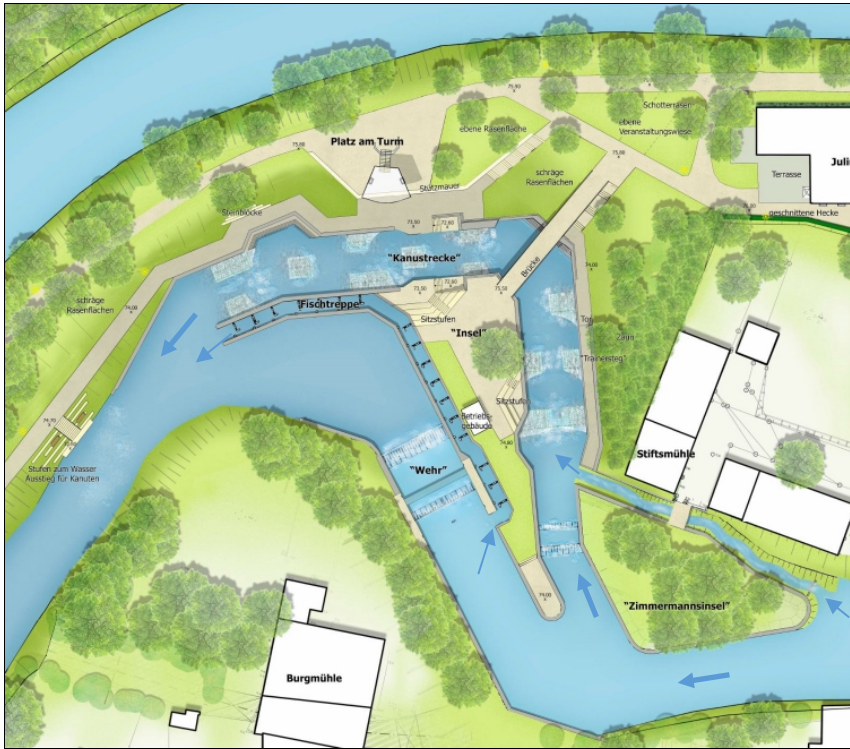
Lageplan Stadtplaner, B.S.L. Landschaftsarchitekten (2019)
